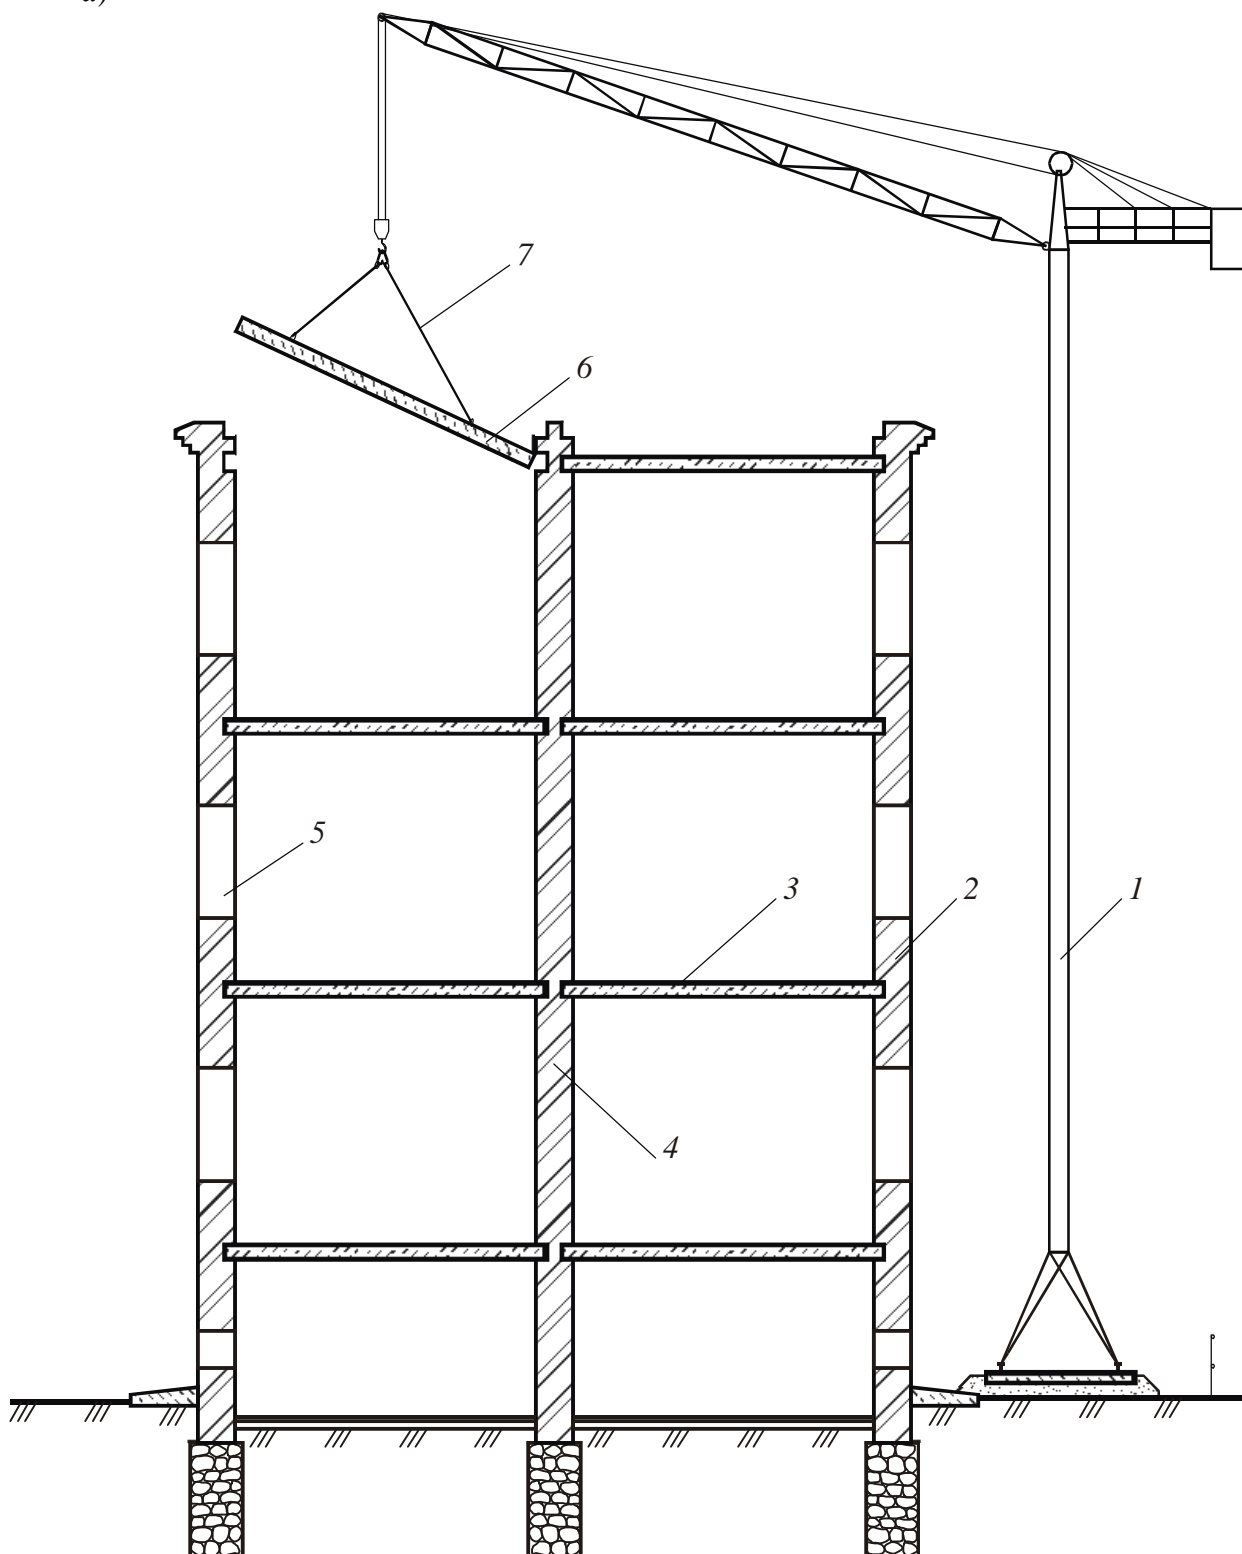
Технологические схемы механизации монтажных работ по устройству перекрытий из среднеразмерных элементов при помощи:
